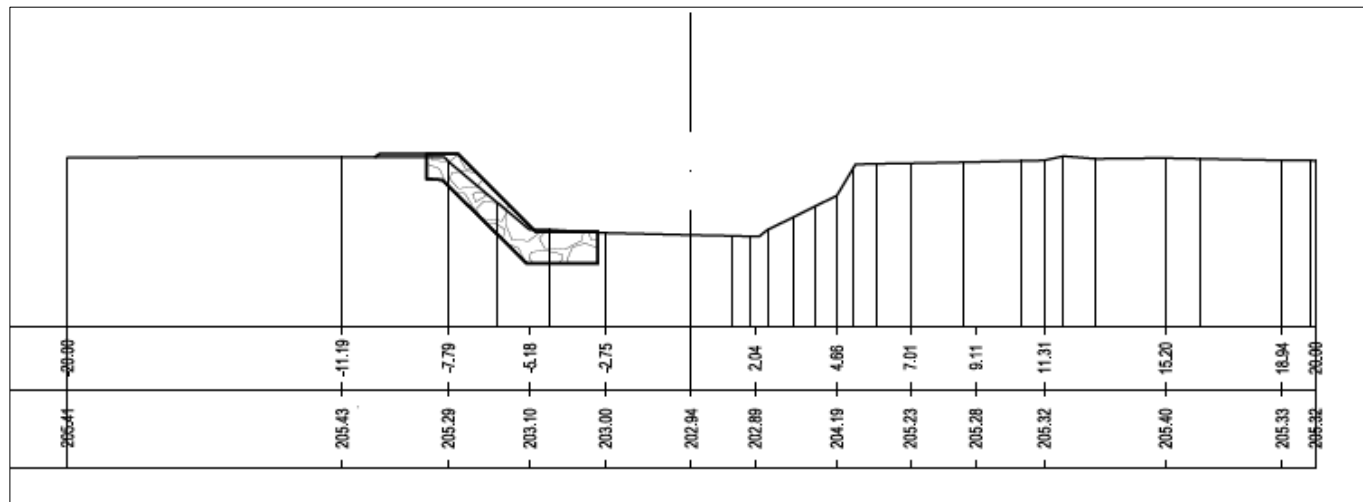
Sezione 1 delle opere di sistemazione idraulica (vd. planimetria in figura precedente).
